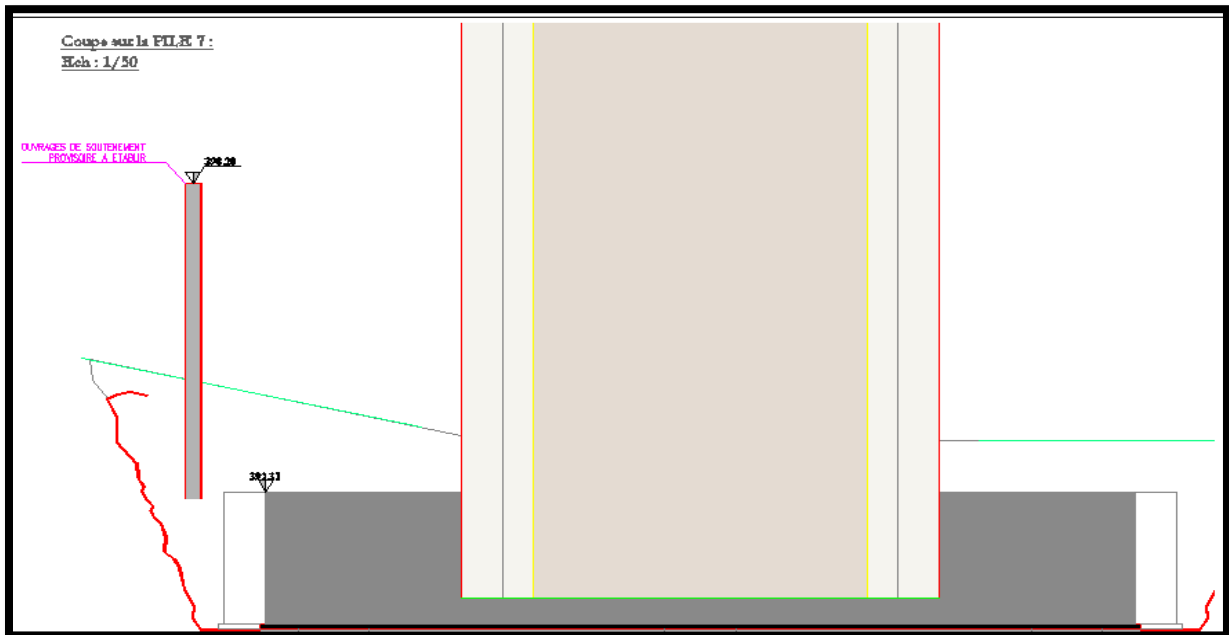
Coupe sur la pile 7 avec l'ouvrage de soutènement
